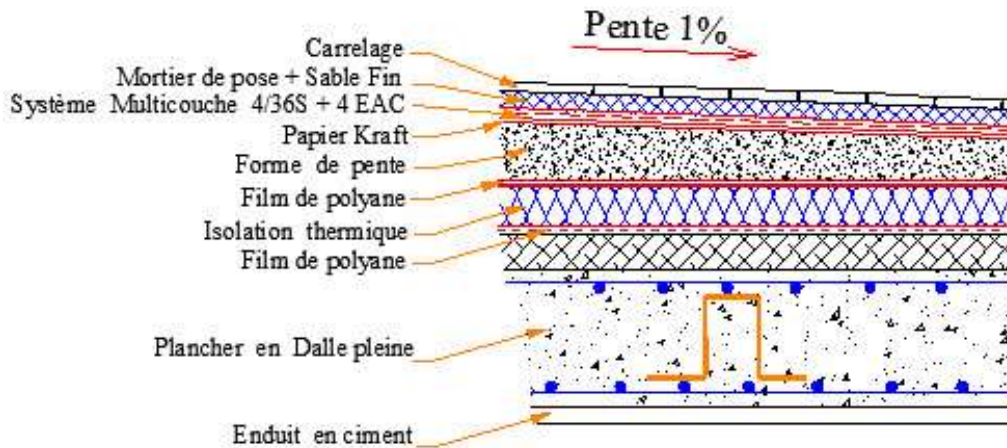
Coupe verticale du plancher terrasse accessible (Dalle pleine)
